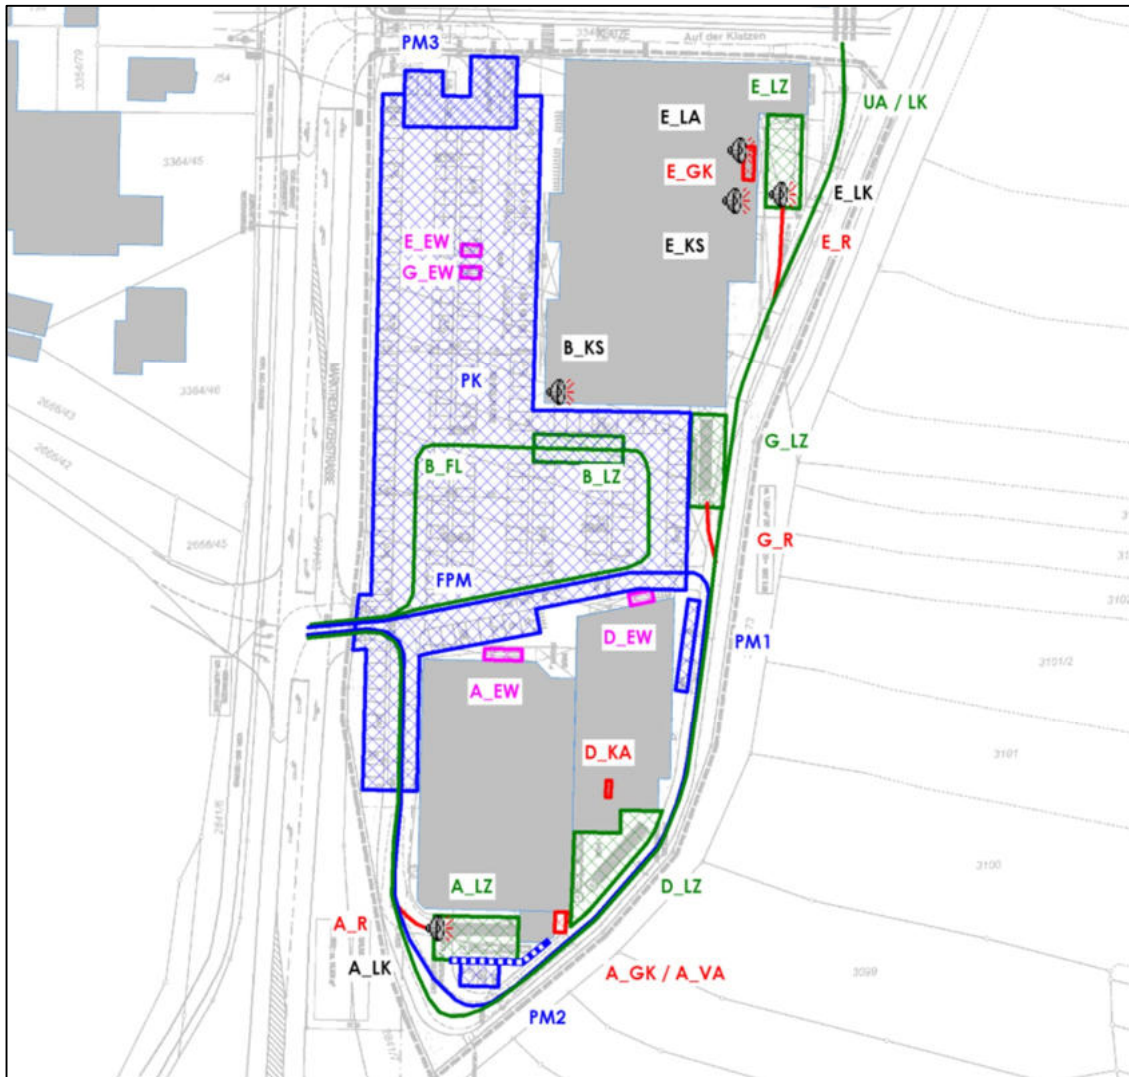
Lageplan /18, 31/ mit Darstellung der relevanten Schallquellen
